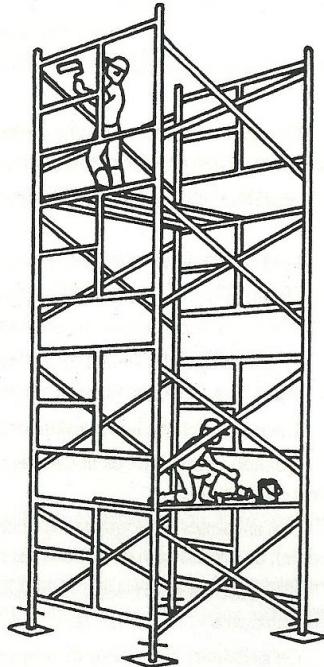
Exemplo de andaime simplesmente apoiado fixo.
